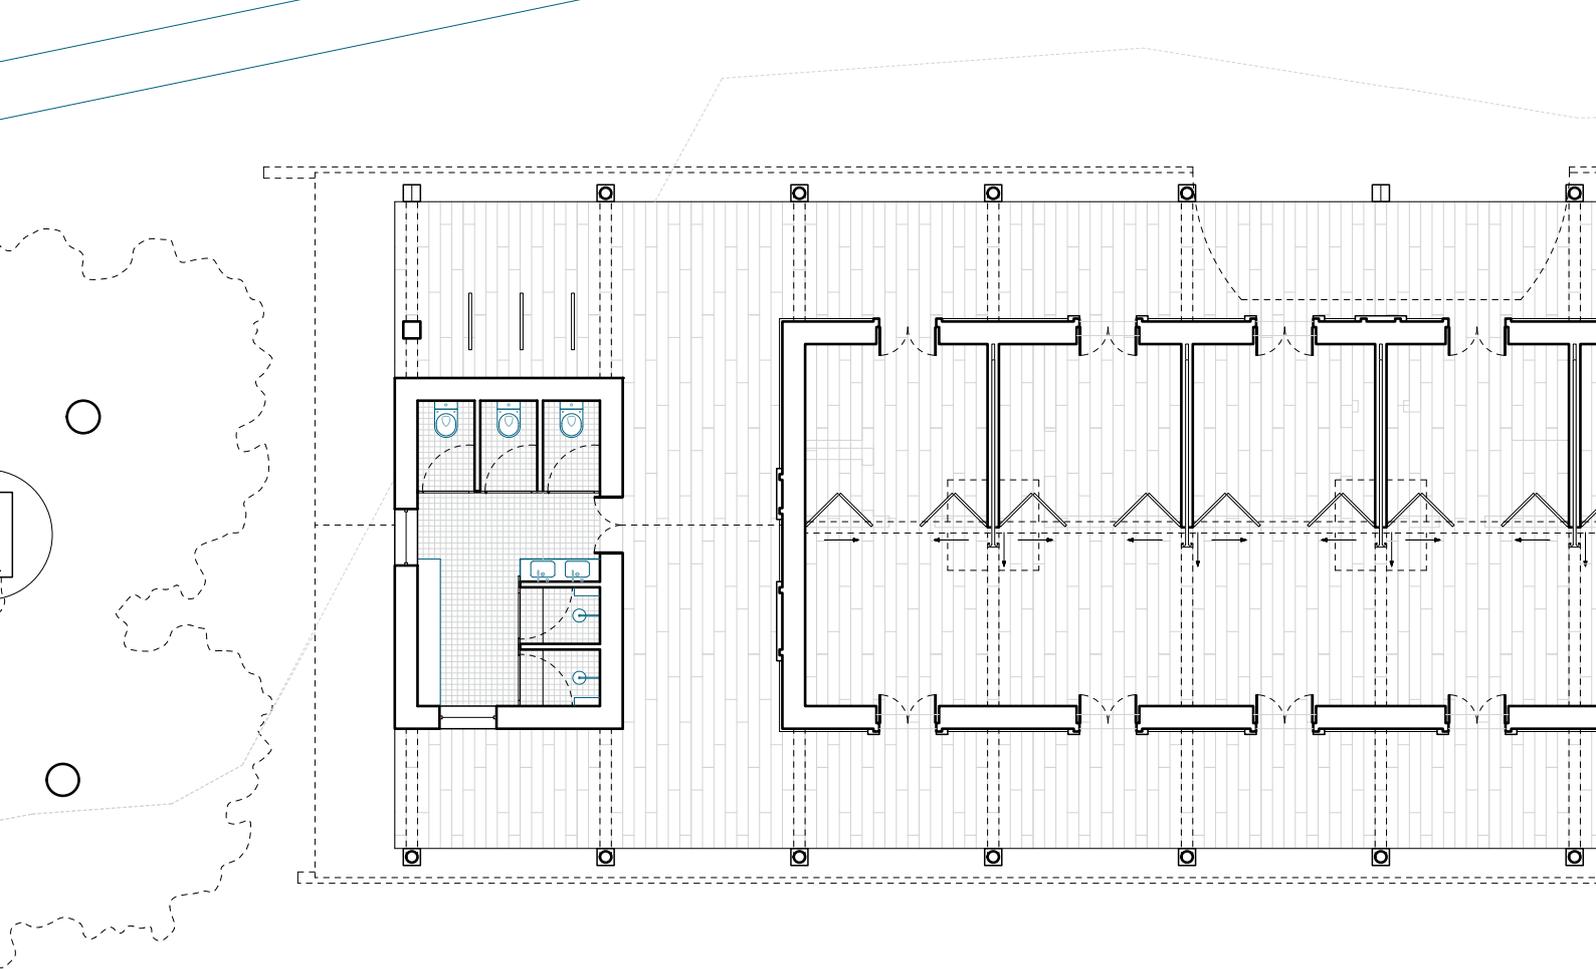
Planta da proposta para a antiga casa do Pessôal (Casa grande)
